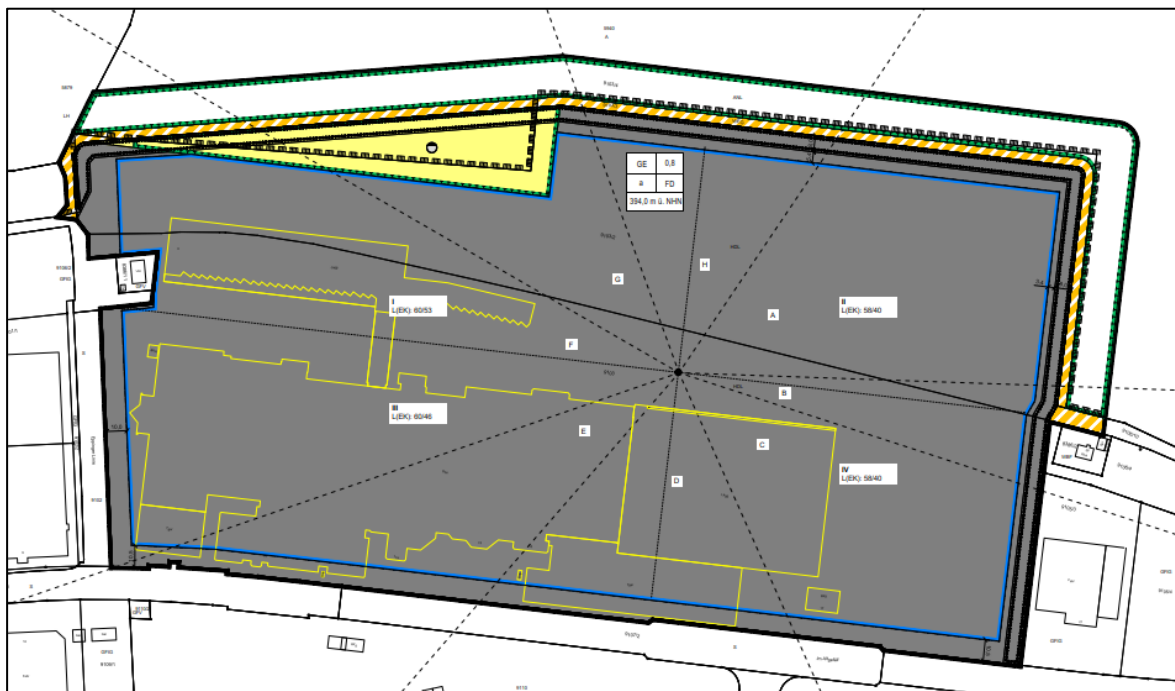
Planung Bebauungsplan, 1. Änderung „Frauenwald“ (ohne Maßstab)
